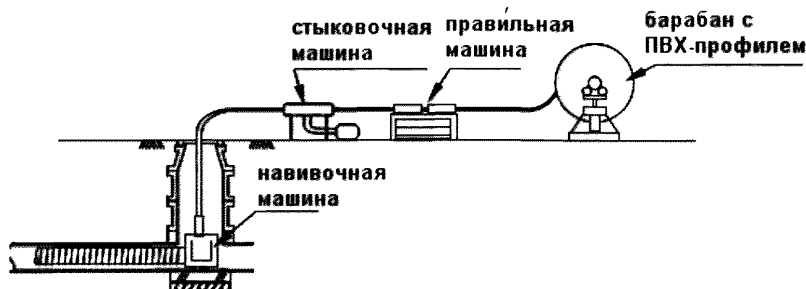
Размещение оборудования при сварке ПВХ-профиля
